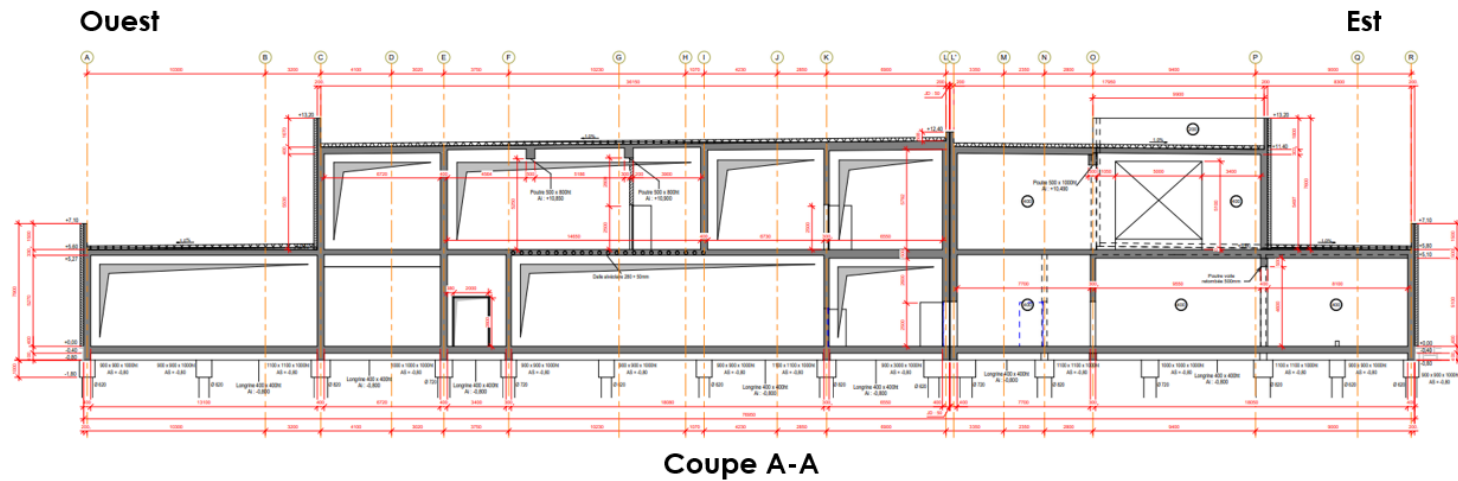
Coupe A-A du BSHE – CEA – Sans échelle
